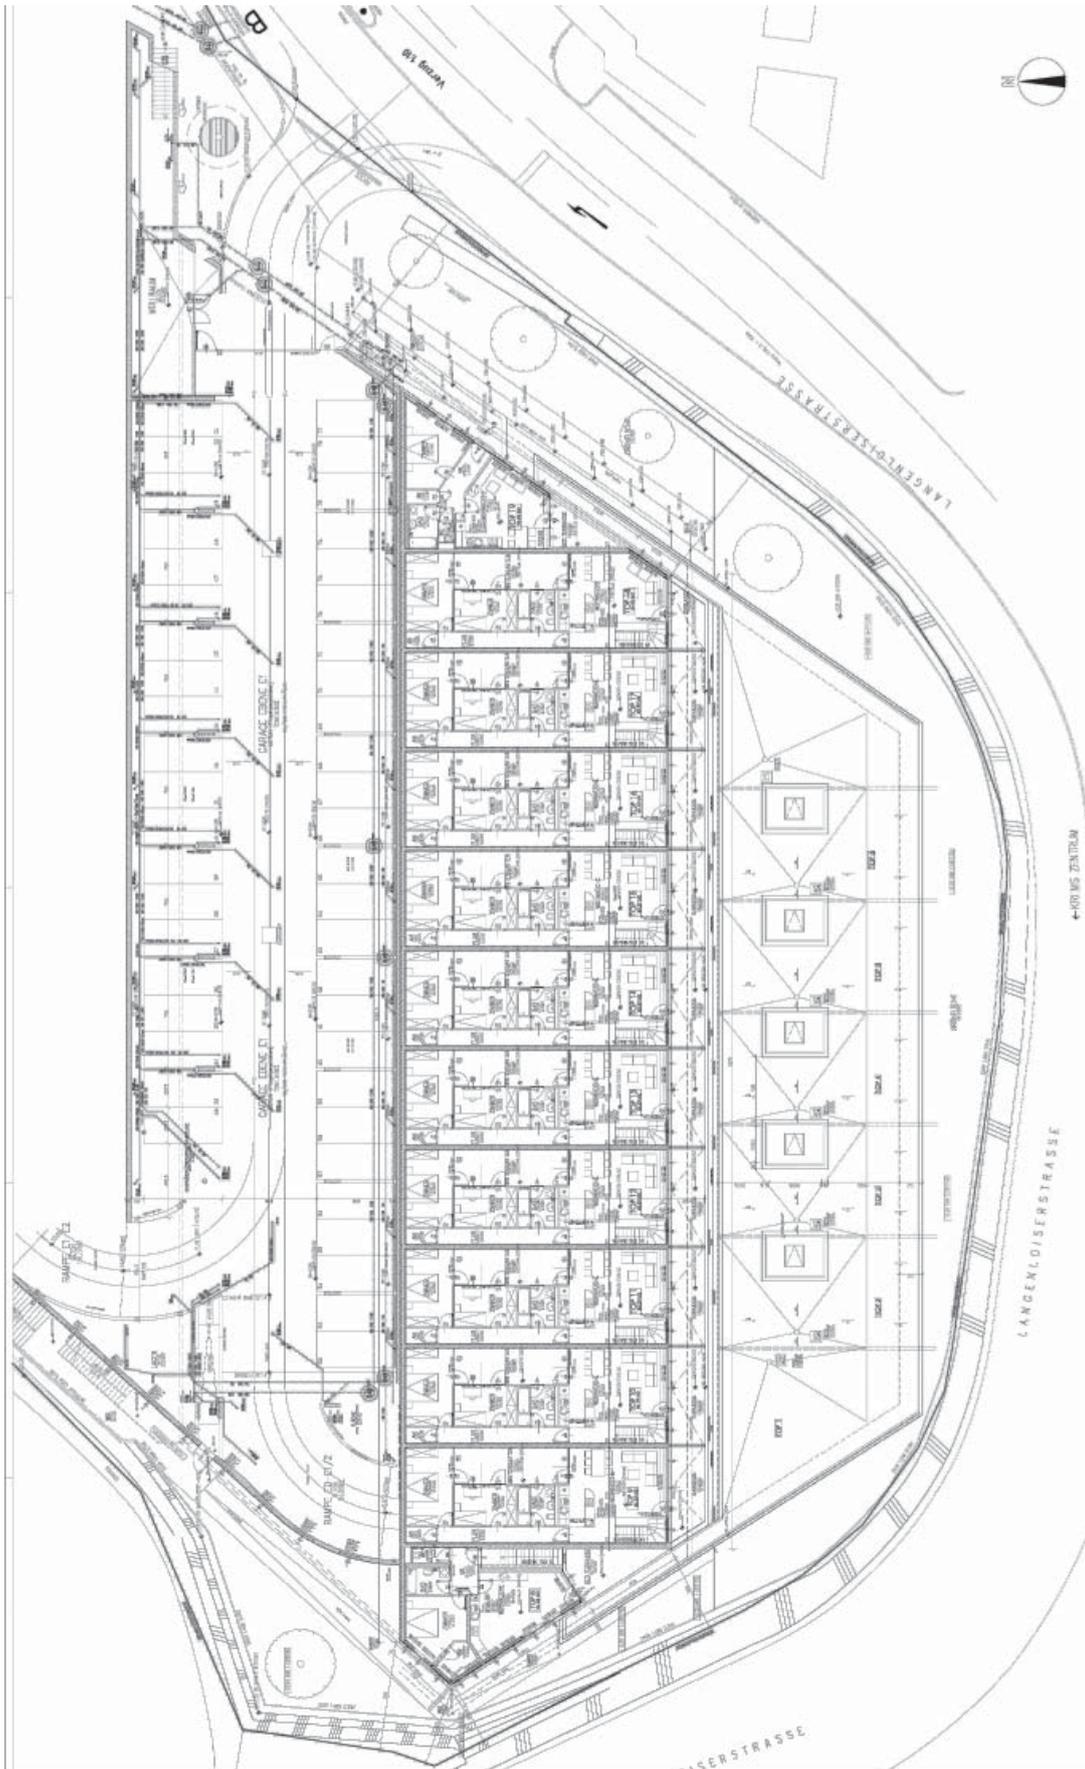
Lageplan Ebene 1, Terrassenhaus „Langenloiserberg“, Quelle: Archiv Architekt Linsberger
